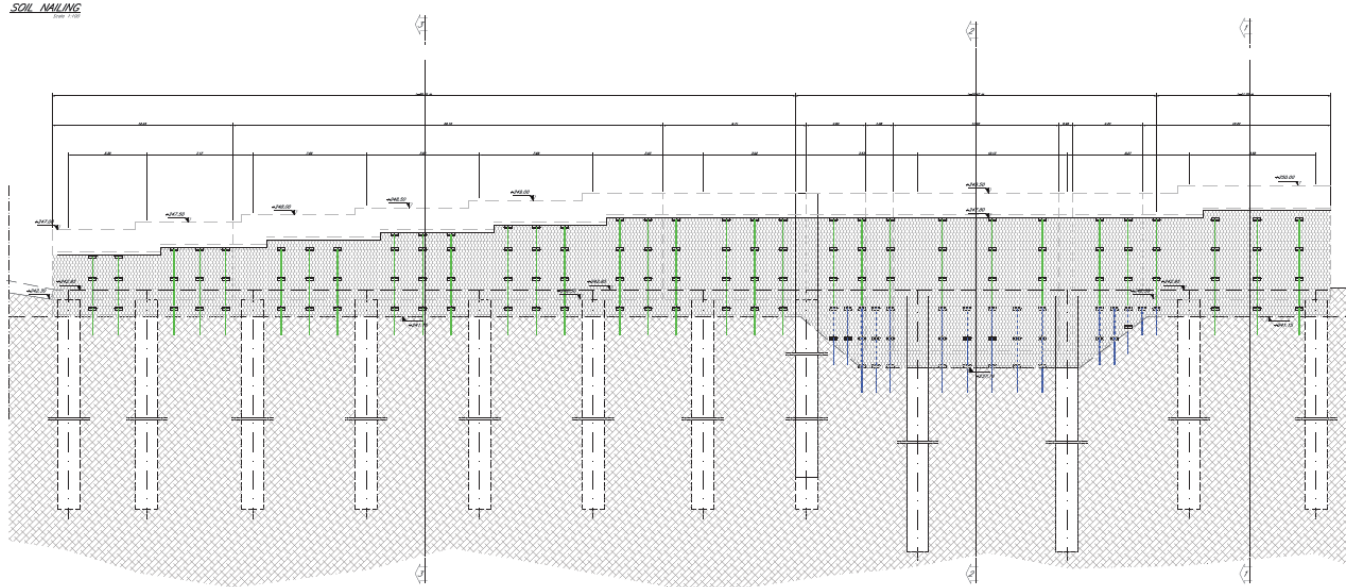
Estratto da sviluppata intervento soil-nailing [27]
